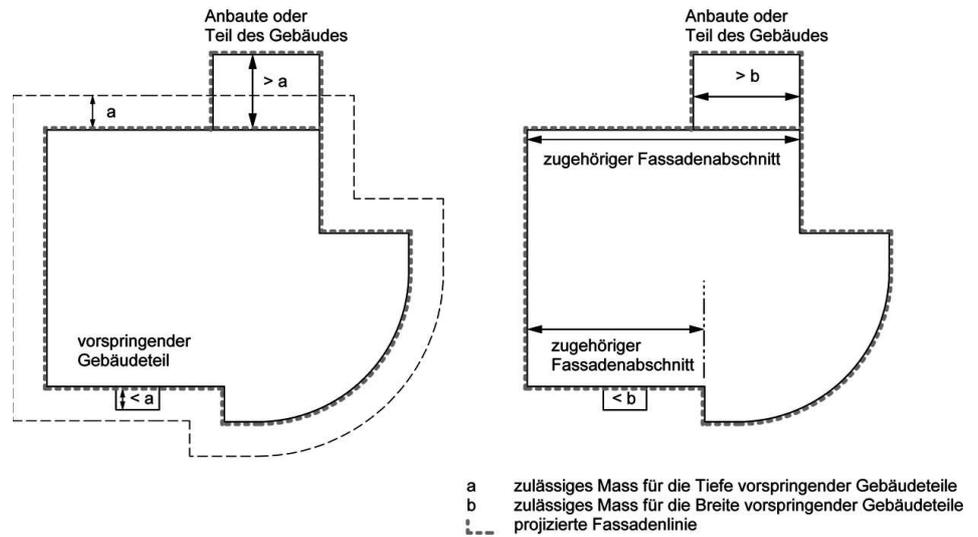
a Fassadenflucht und Fassadenlinie (in ebenem Gelände)
